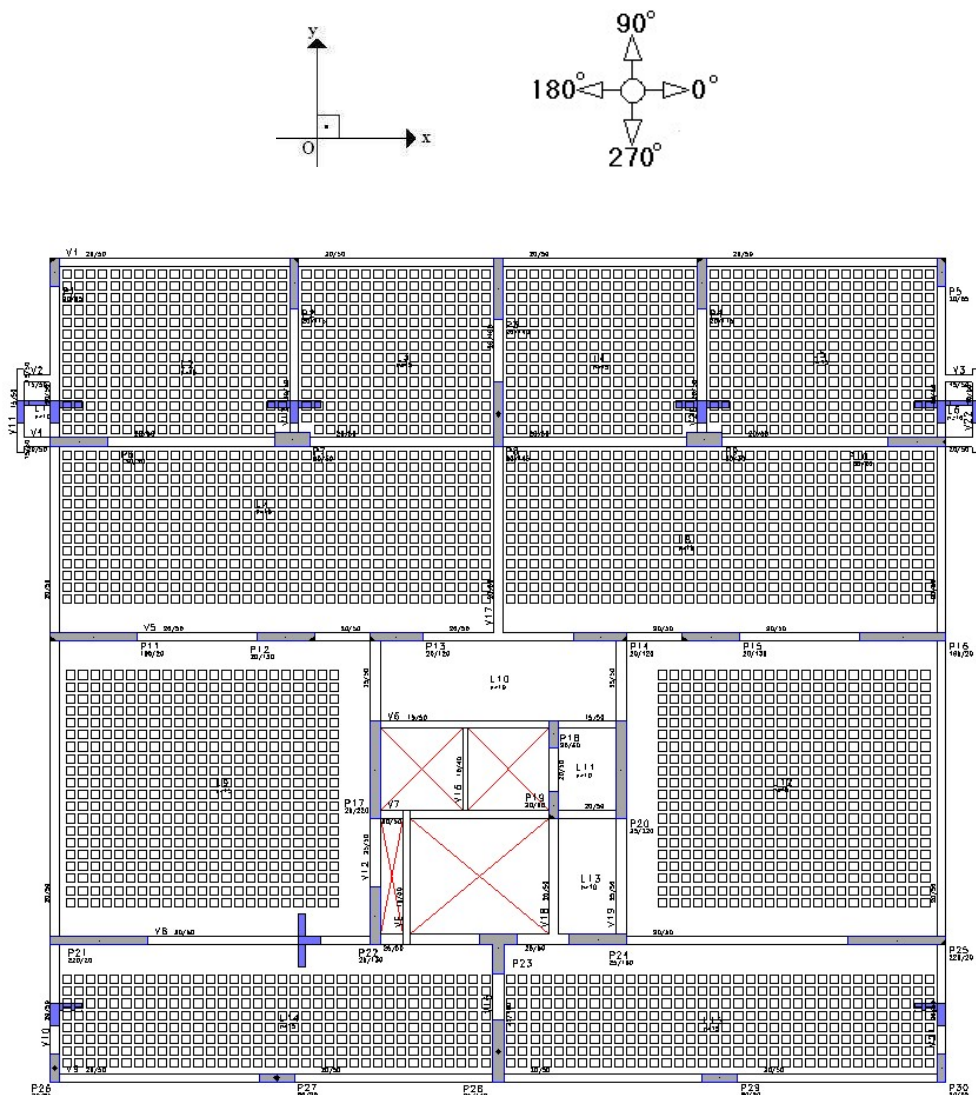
Forma da estrutura pavimento tipo, modelo 2.
